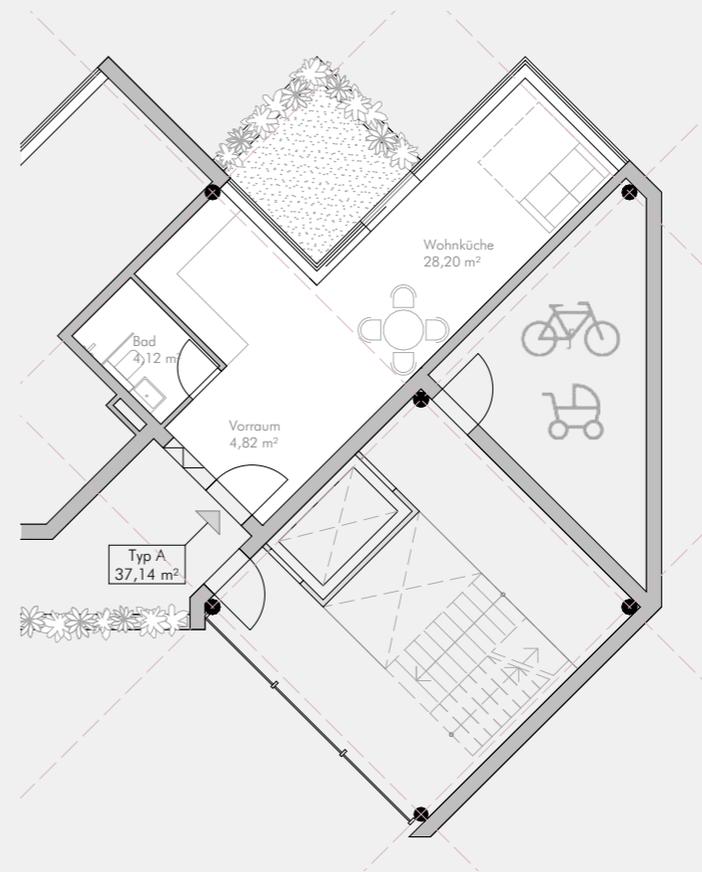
| Grundriss einer Wohnung des Typs A im Maßstab 1:150
